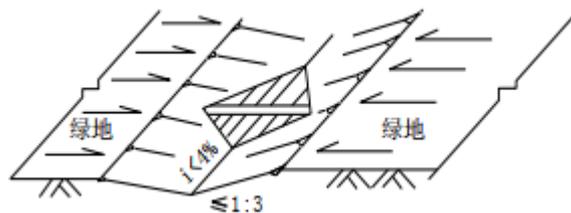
转输型三角形断面植草沟典型构造示意图
